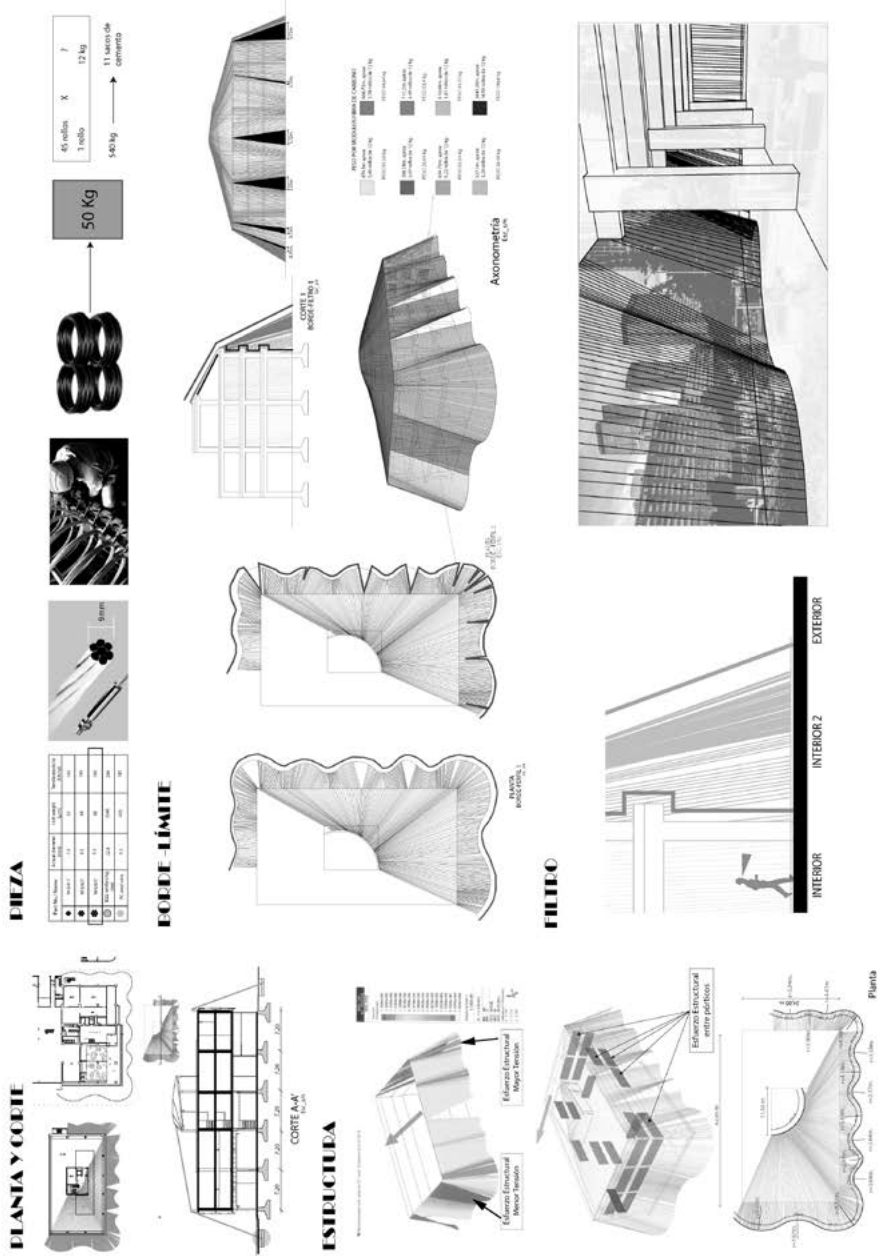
Planos, Estructura, Pieza, Borde – límite, filtro Komatsu Seiren. Fuente: Elaboración propia.
